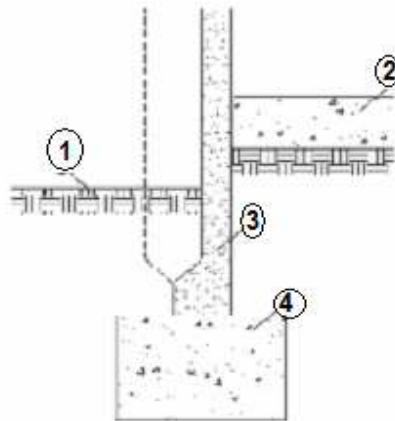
Cimentación en paneles ligeros. Detalles. 1-Terreno, 2-Solera de hormigón, 3-Panel prefabrica
